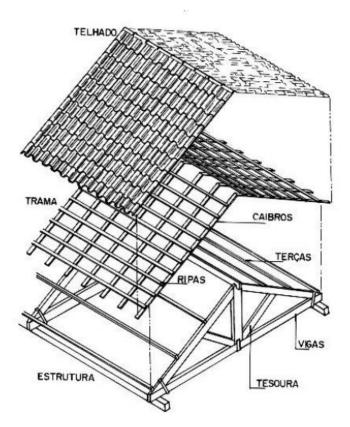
Estrutura de telhado tradicional de madeira. Fonte: RODRIGUES. 2006.
